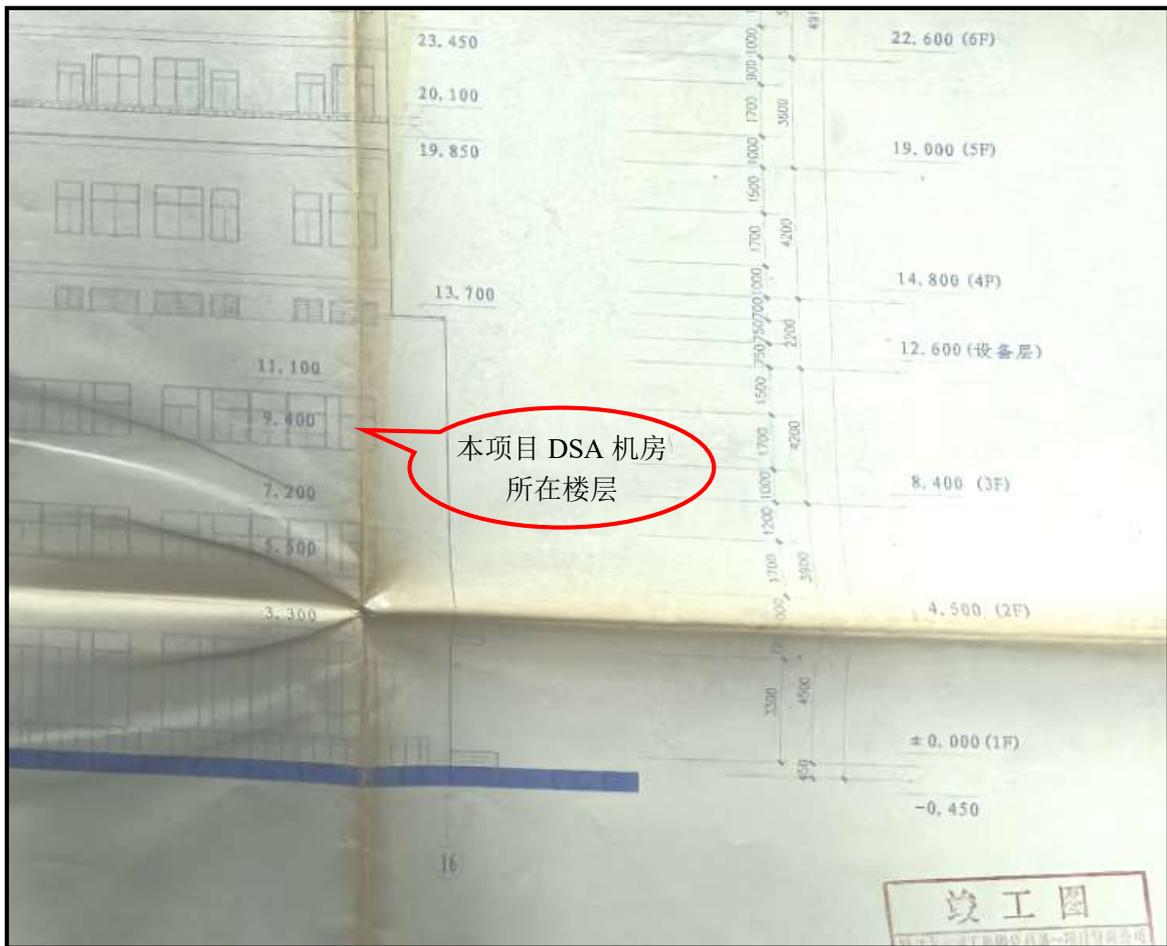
福建省肿瘤医院内科大楼立面图（局部）
